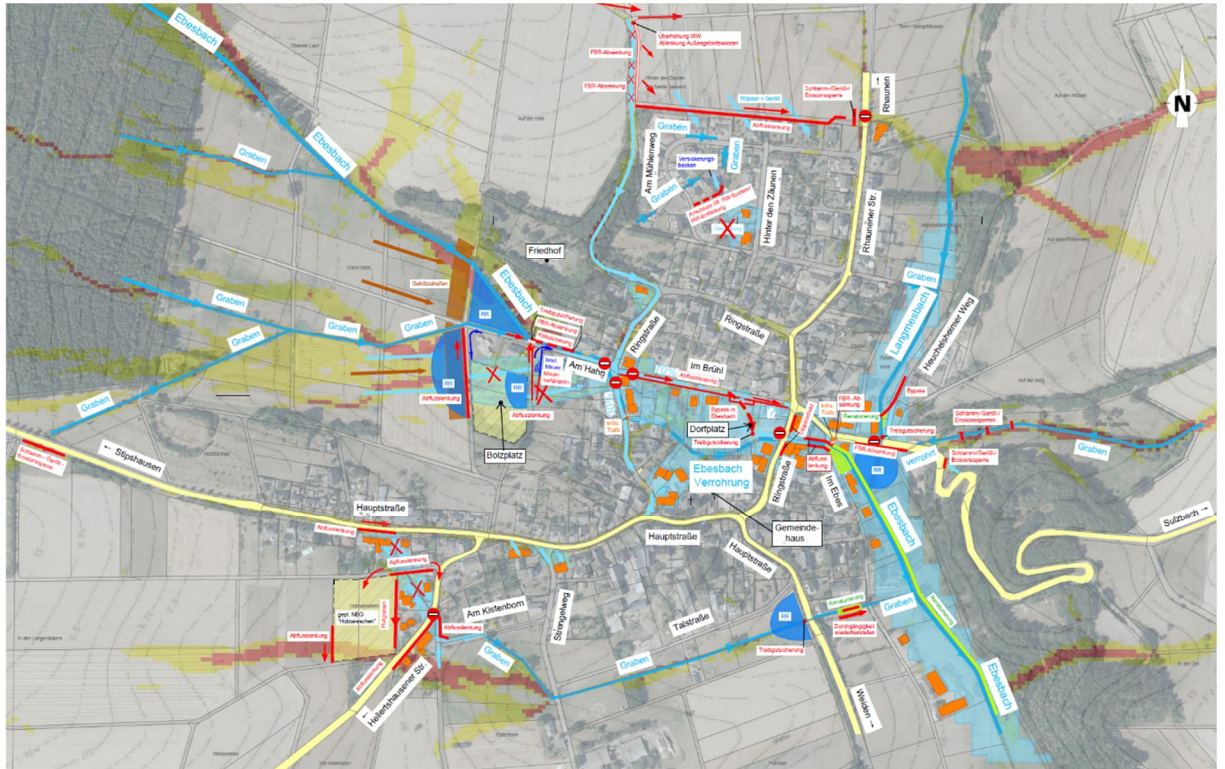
IGB; Lageplan Ortslage Hottenbach
